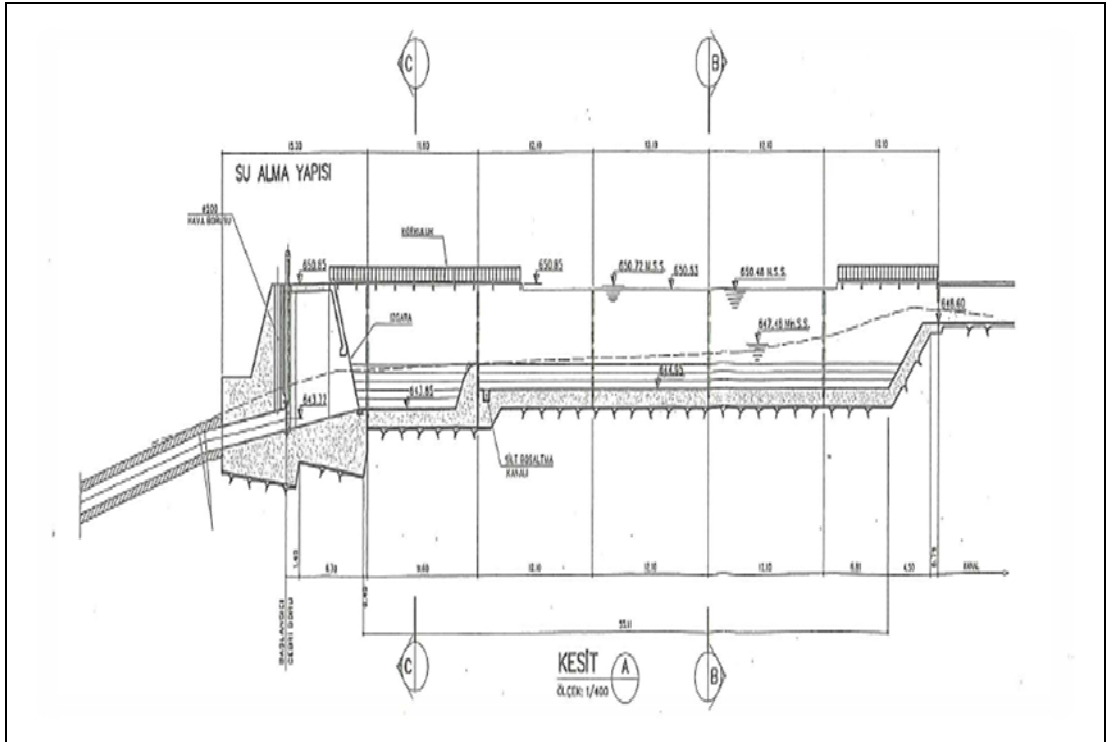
Yükleme havuzu genel yerleşim planı.
